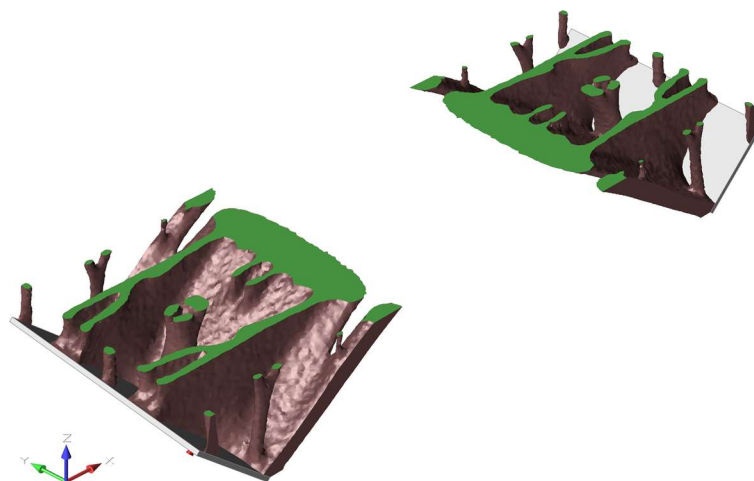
3D-Brücke horizontaler Schnitt -1,0 m
